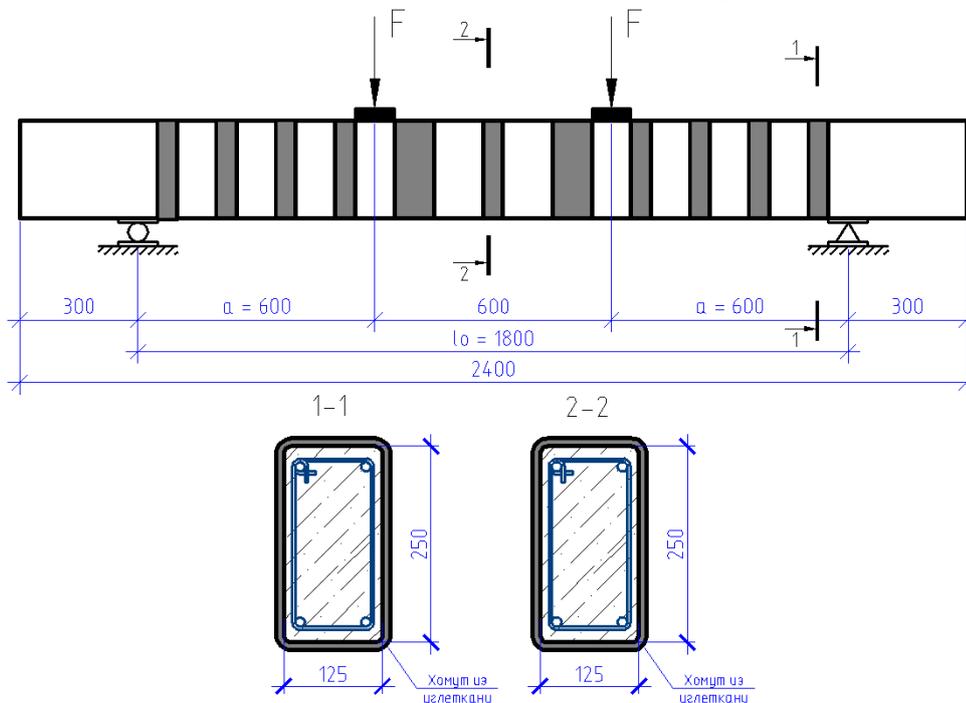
Вариант балки, дополнительно усиленной конструктивной поперечной арматурой в зоне чистого изгиба (Авторская разработка)
